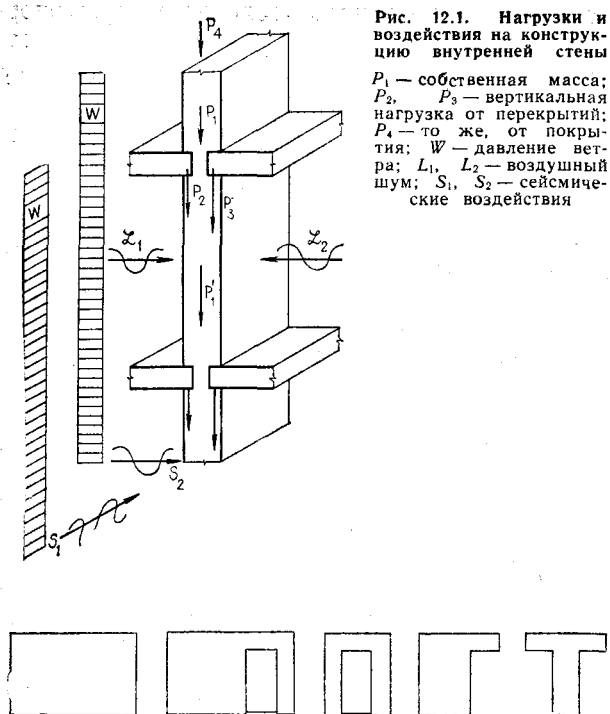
Нагрузки и воздействия на конструкцию внутренней стены
